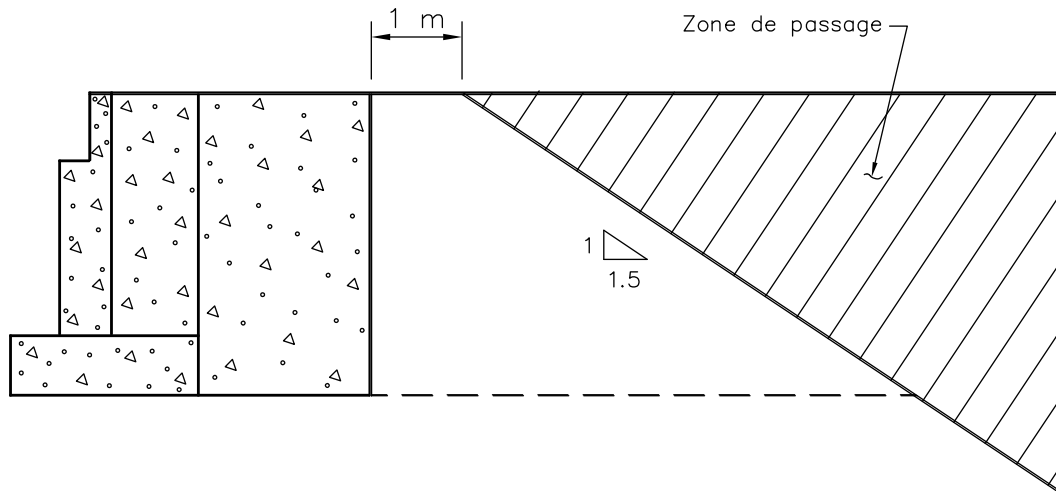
Zone de passage d'un conduit ou d'un groupe de conduits au bout d'un mur
